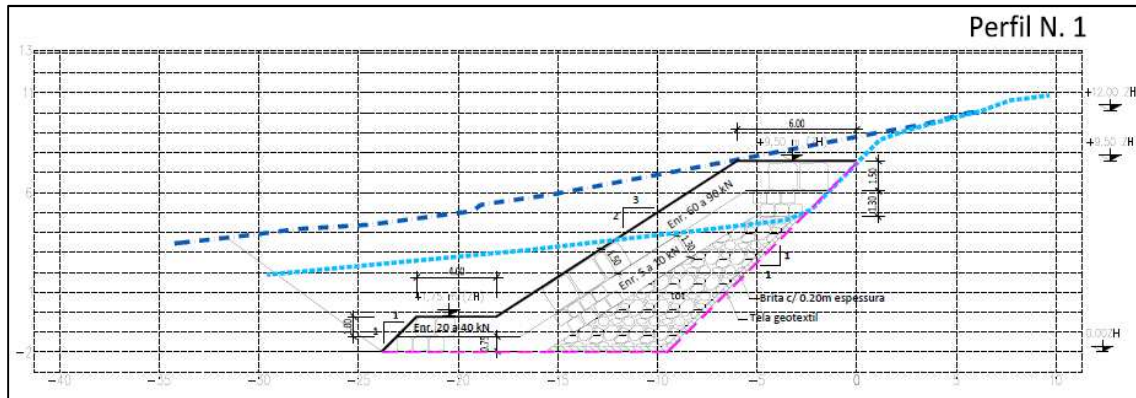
Troço do Centro Azul – Perfil 1 (fonte: APA, fevereiro de 2014)
